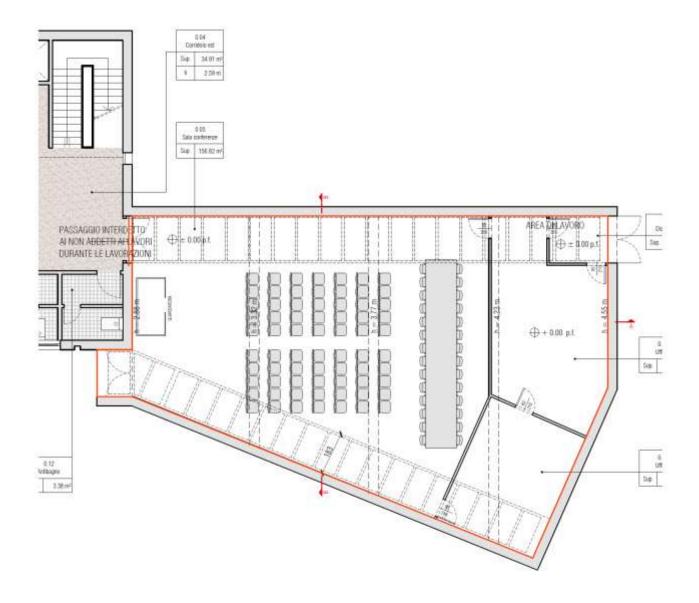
Particolare area di cantiere lotto 3 - piano terra
